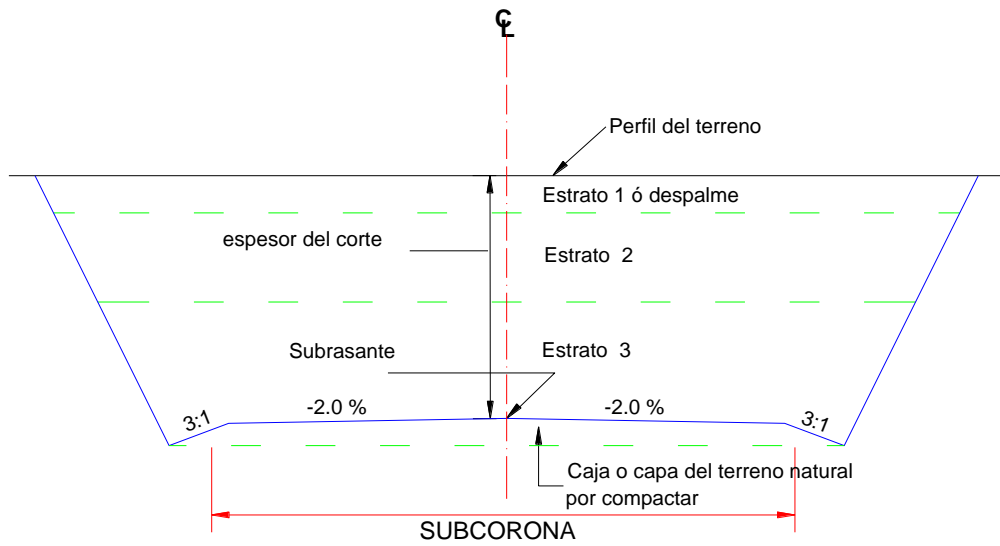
SECCION DE CONSTRUCCION DE UN CORTE EN TANGENTE
